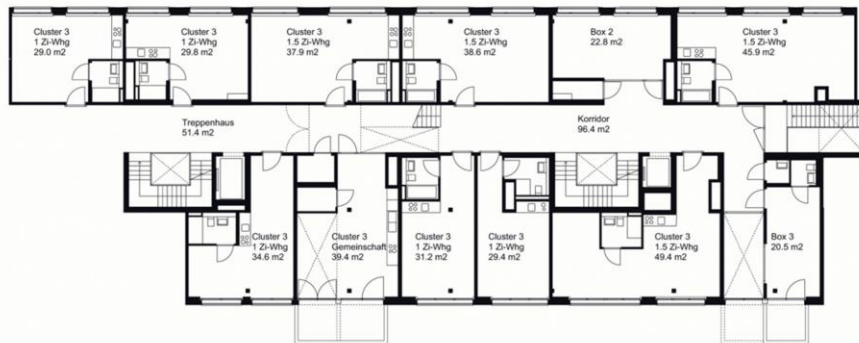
Apto. de 1 habitación, cluster: espacio de estar colectivo y planta. Fotos: 20min.ch, planimetría: Müller Sigrist.
